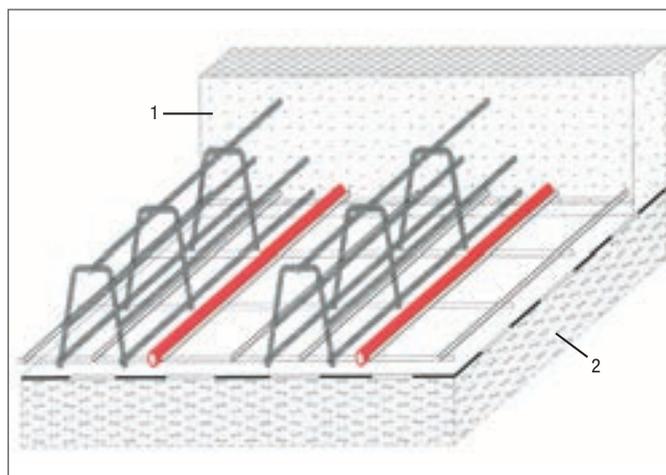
Piano di fondazione in cemento armato con reti in acciaio; costruzione speciale con tubi di riscaldamento montati al centro del piano di fondazione
